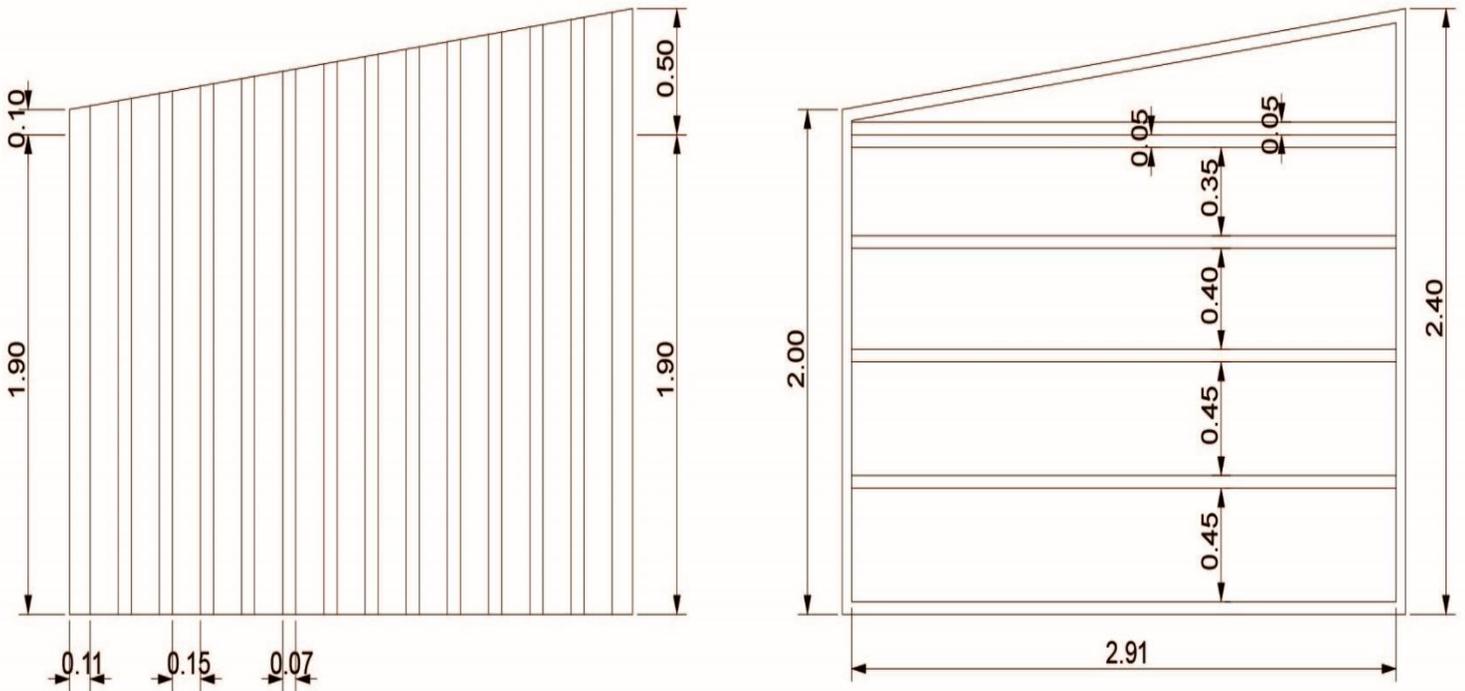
Diseño interior y exterior del panel ciego de la vivienda de TECHO
